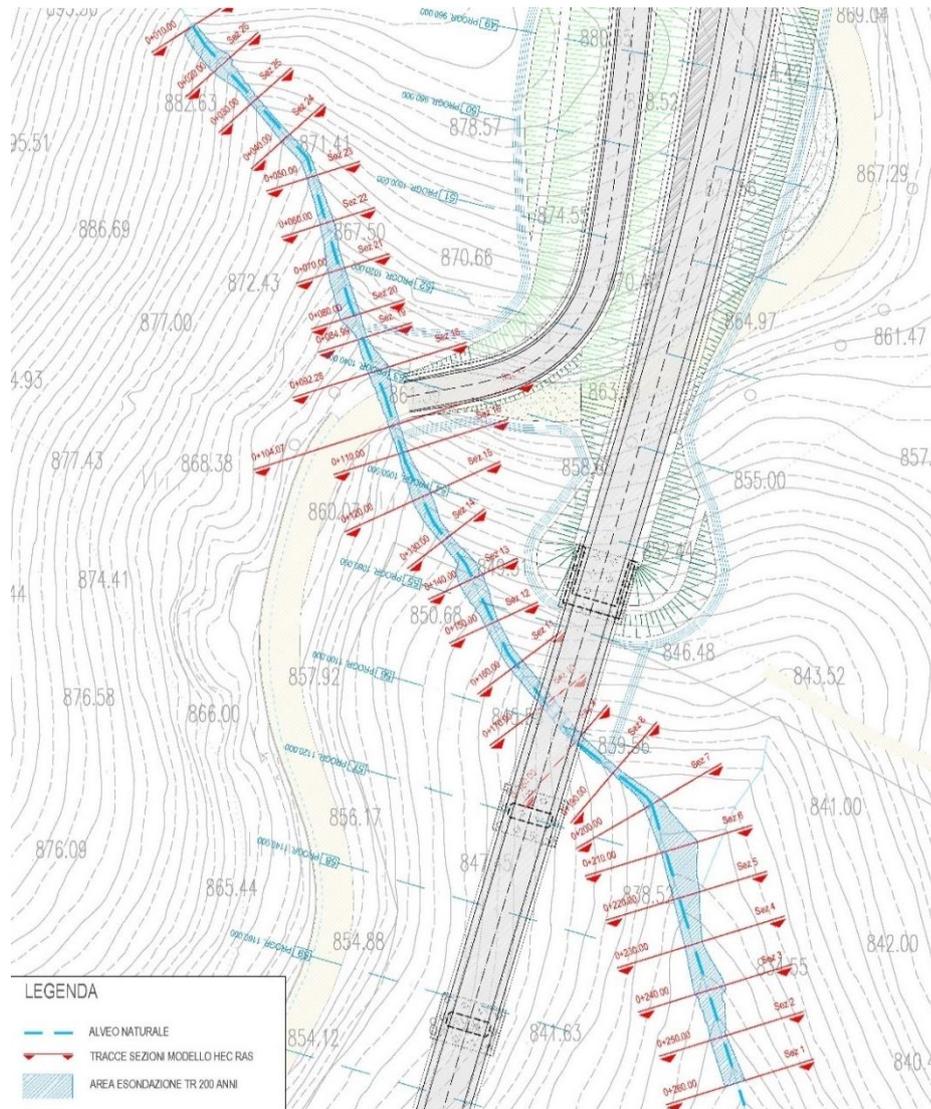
Fiume 20774 – Planimetria aree di esondazione.
